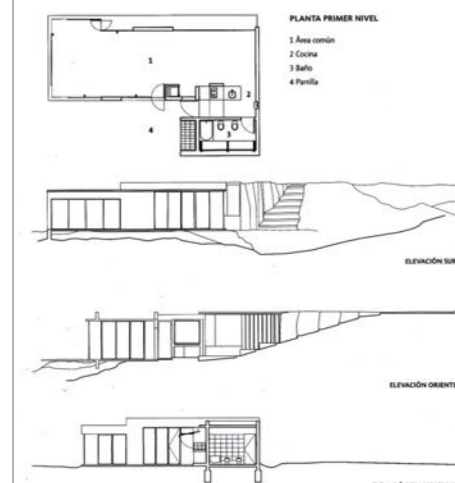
Planta y secciones Casa Meroi- Chaumet, Rafael Iglesia
